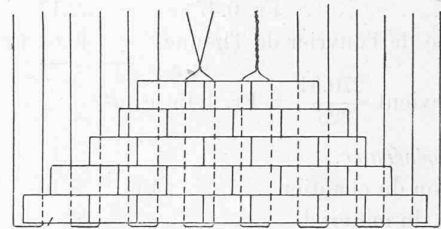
Disposition des étriers en fil N° 20 (4,4 mm.) assemblant la cuirasse de faible hauteur.
